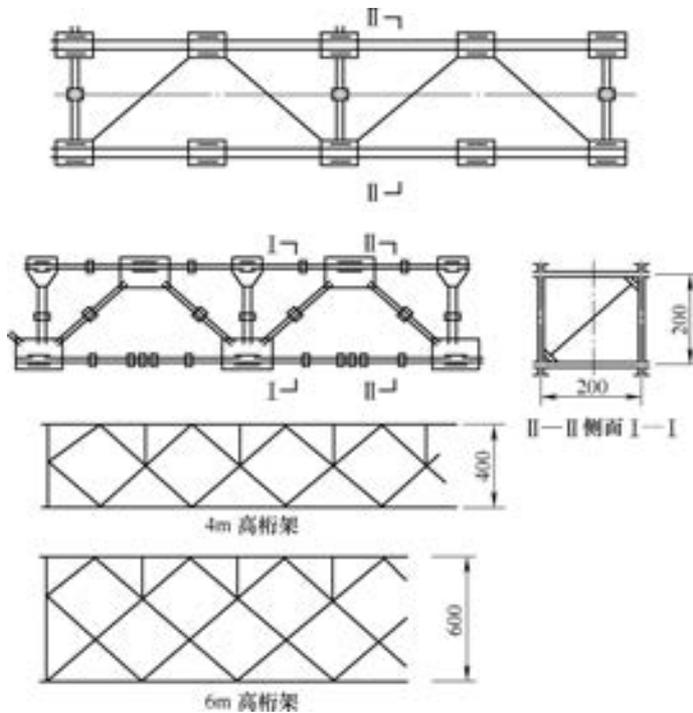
万能杆件组拼桁架示意图 (尺寸单位: mm)
